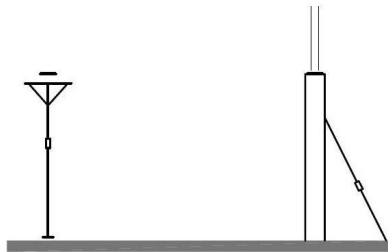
figura esquemática do escoramento e painéis de fundo das vigas
